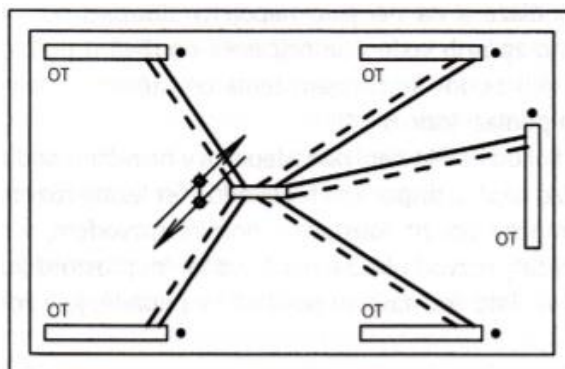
Horizontální otopná soustava ve vícepodlažním domě [8]
